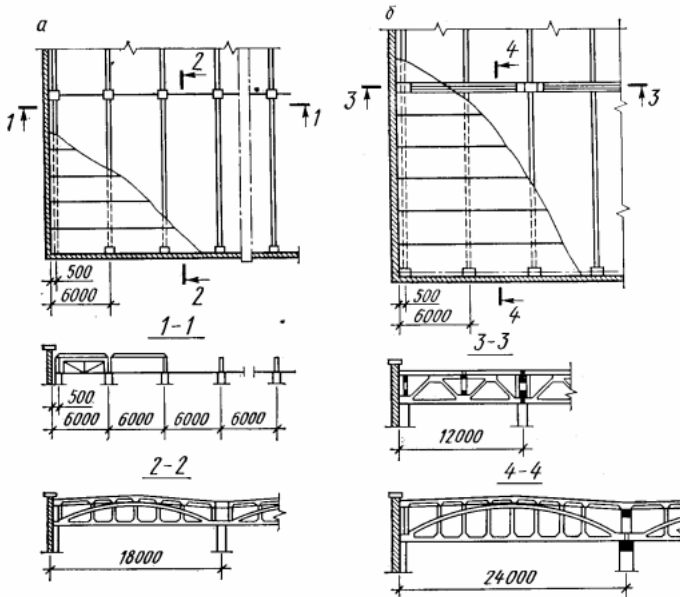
Конструктивні схеми одноповерхової промислової будівлі:
